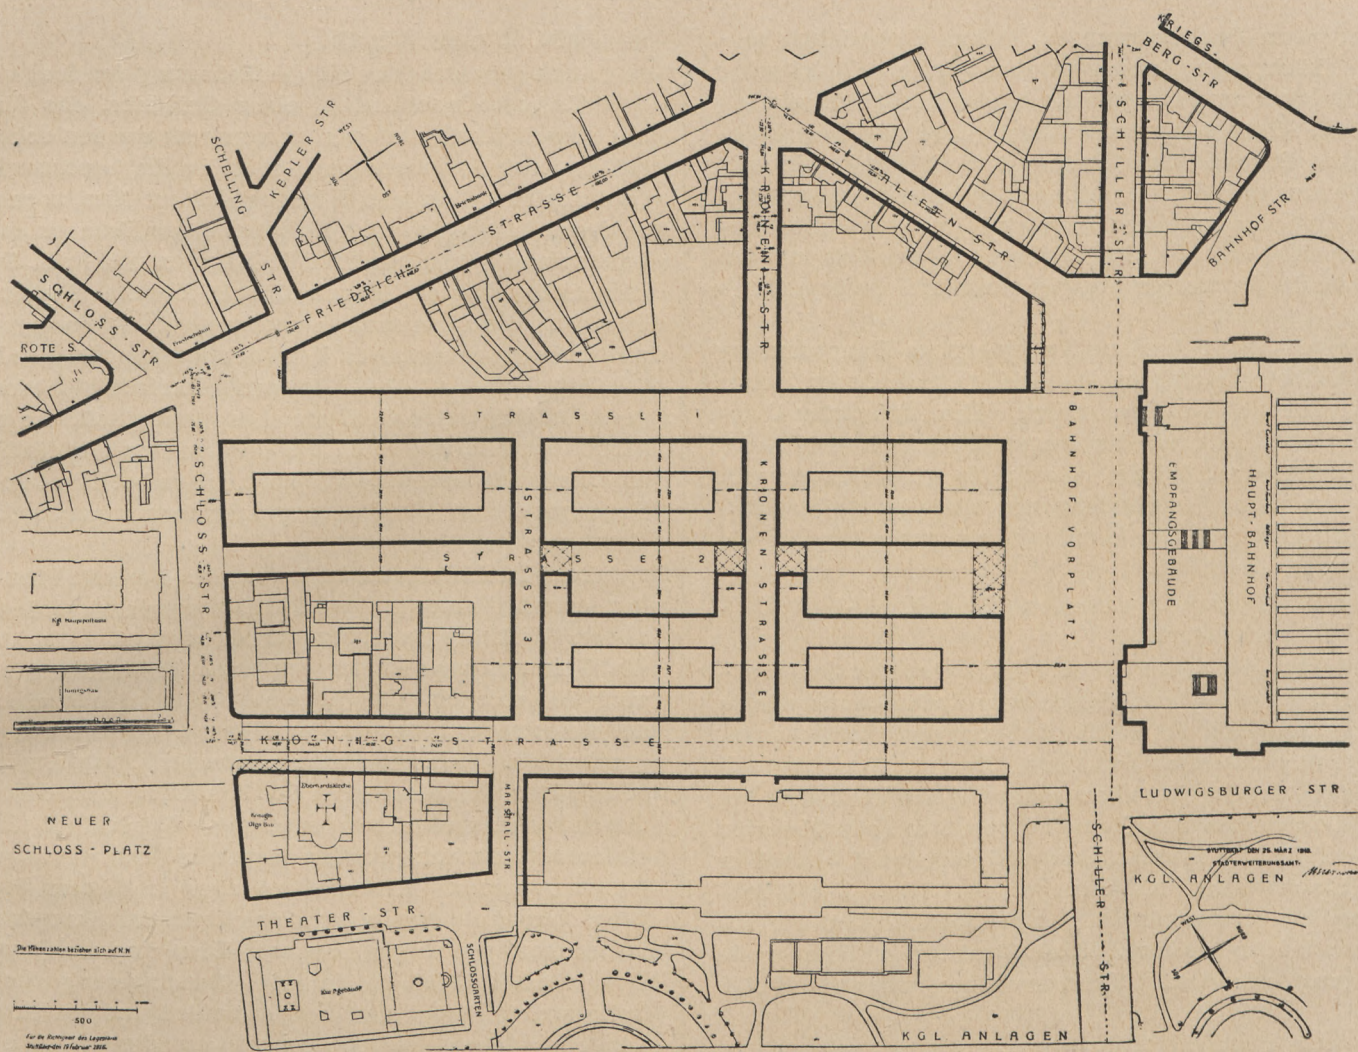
Bebauungsplan für das freiwerdende Bahnhofsgelände, Stuttgart.
